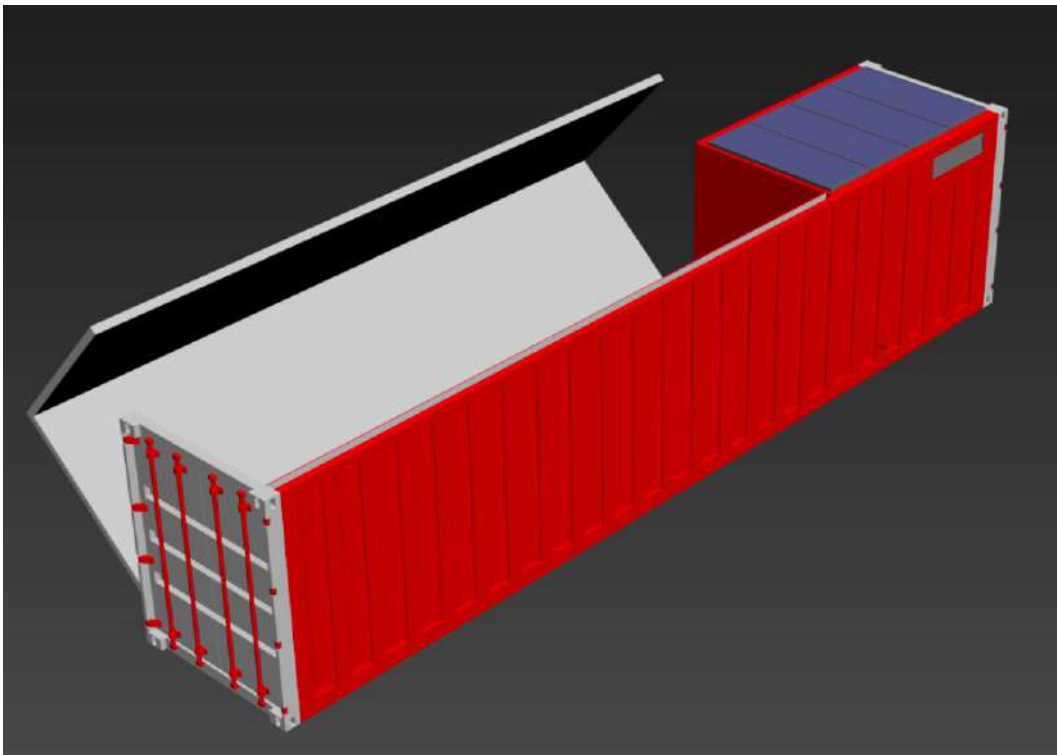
Render detalle apertura y cerrado container “Fuente: Elaboración propia”
